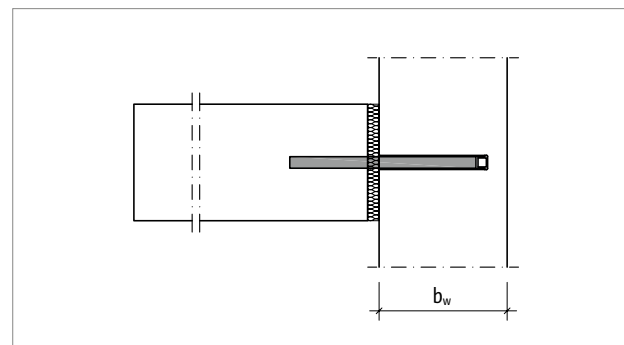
Schöck Stacon® type LD: Minimum structural component thickness of a wall or column
